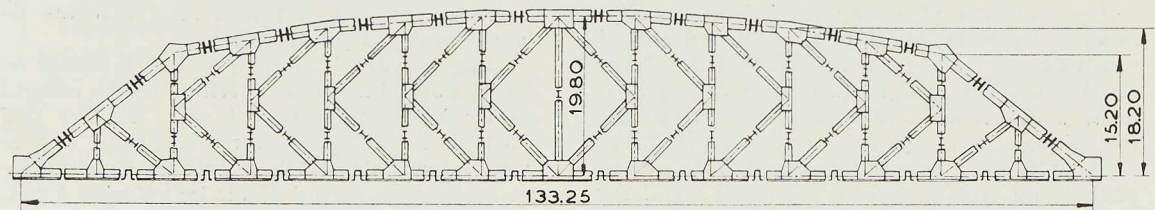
Élévation d'une maîtresse-poutre, avec coupe des éléments.
